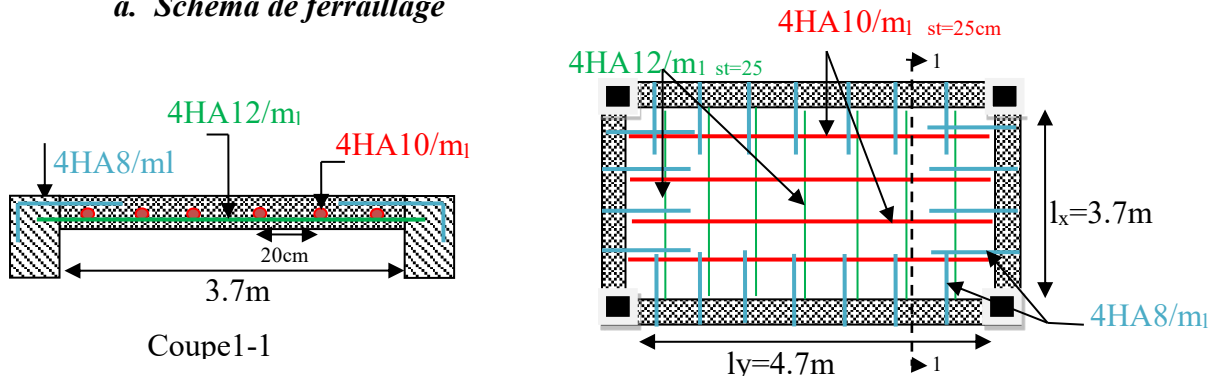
Schéma de ferrailage de la dalle poste transforme
